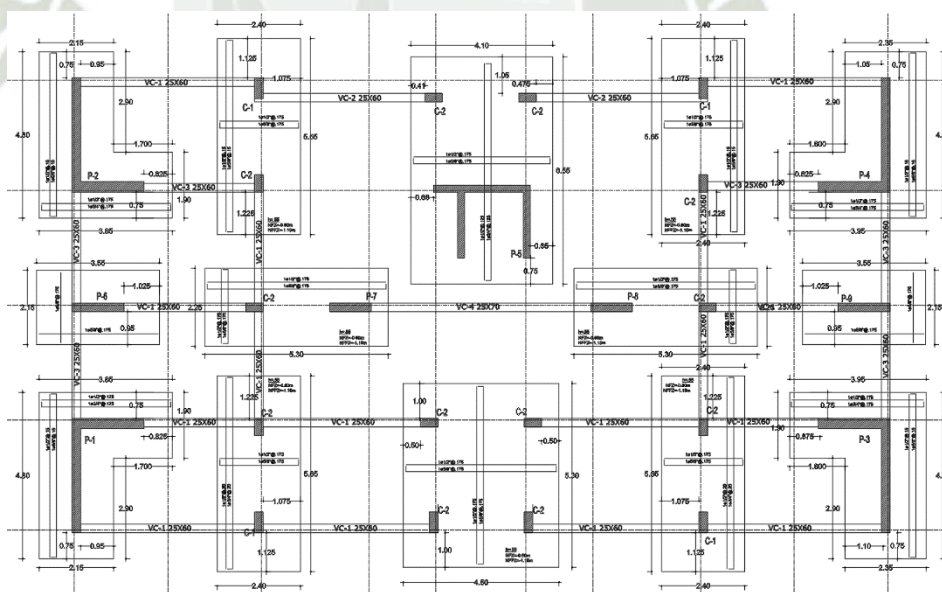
Plano de planta de zapatas y vigas de cimentación
